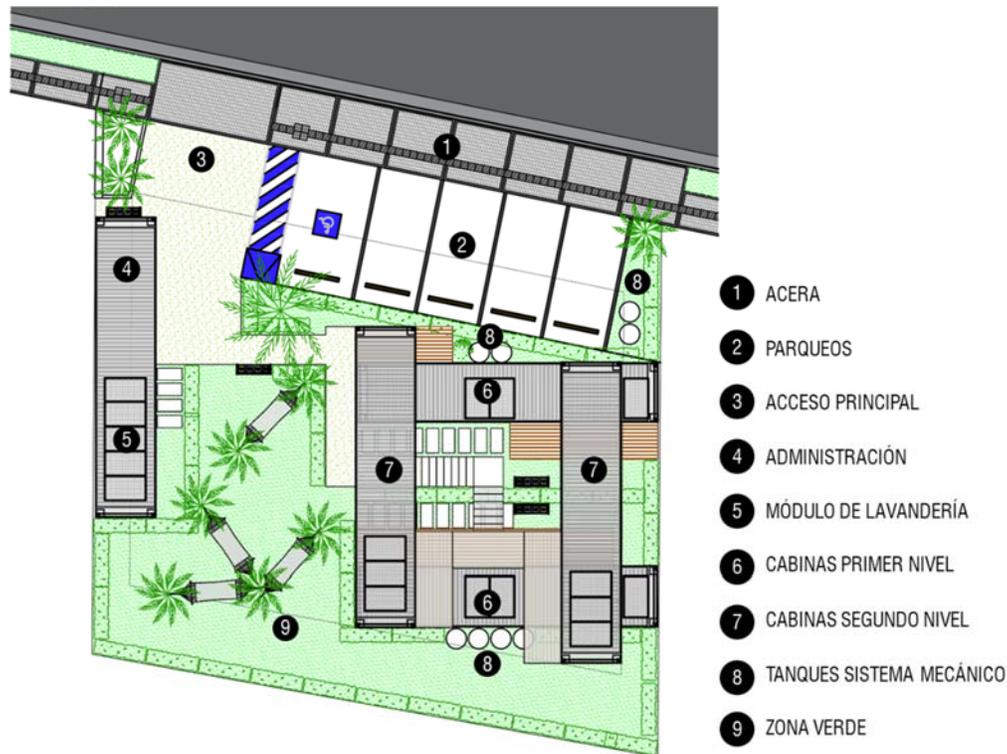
Planta de Conjunto del Proyecto. Elaboración Propia.
